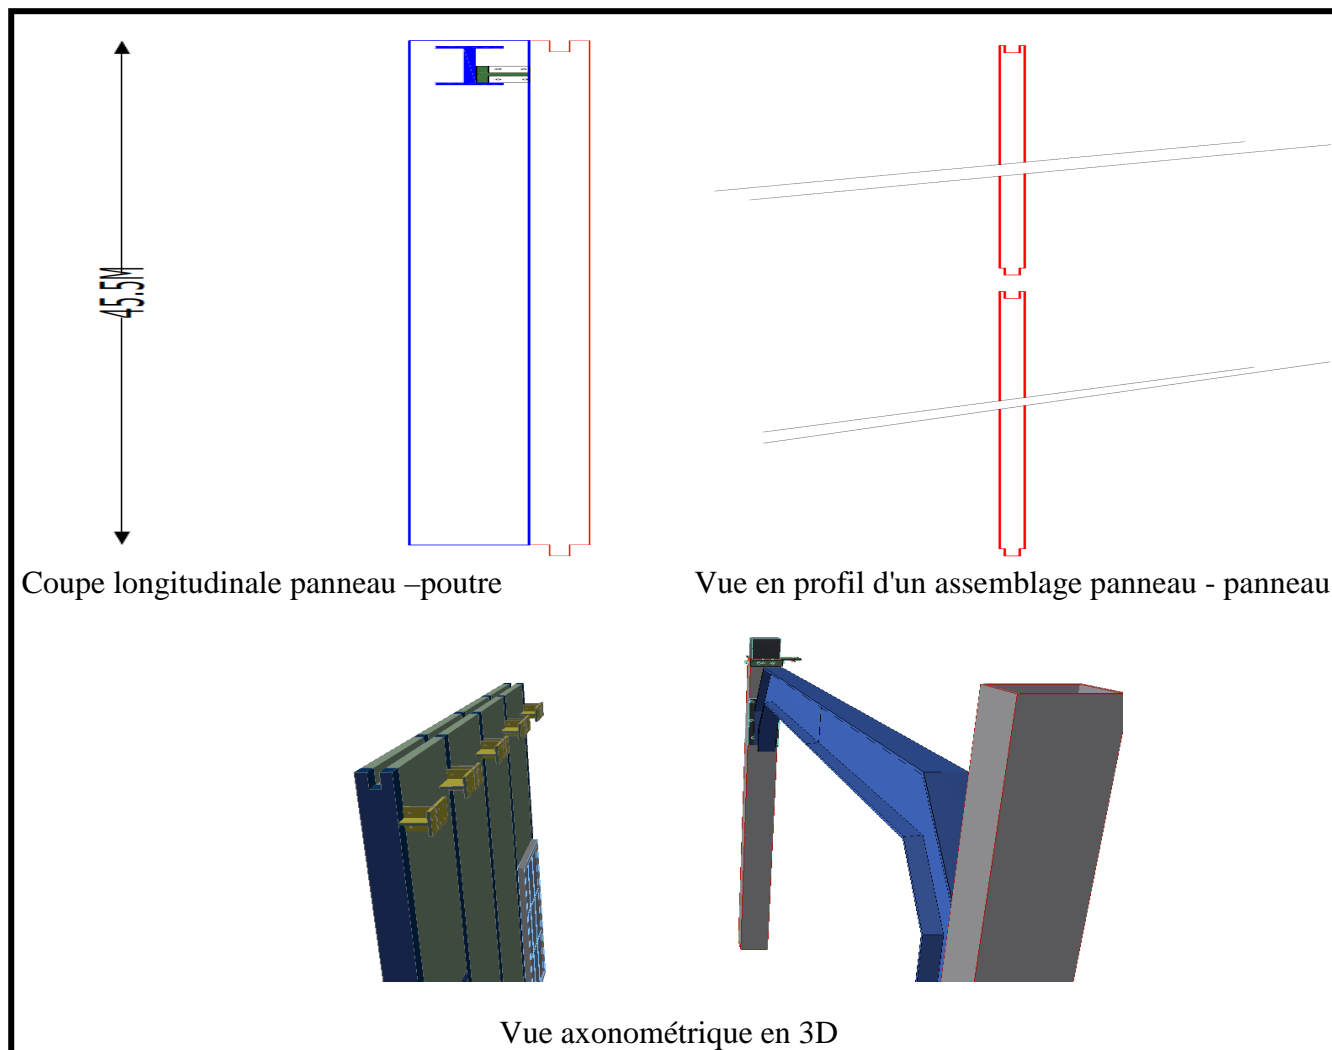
Détail d'un assemblage panneau- poutre et panneau- panneau
